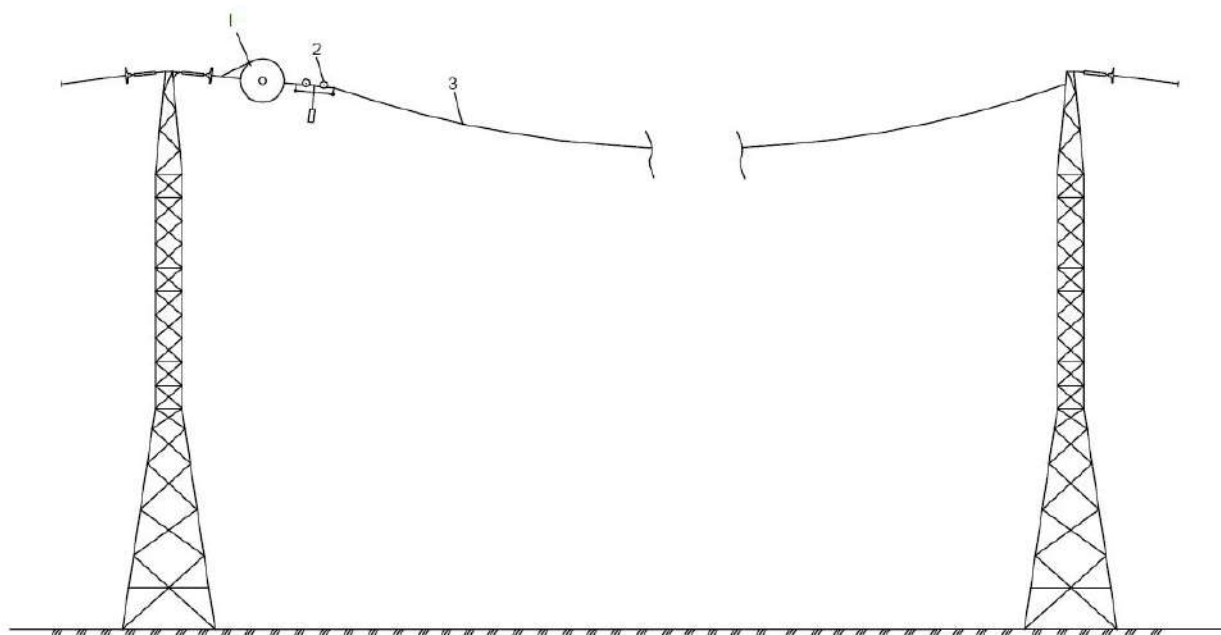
Схема расстановки механизмов и приспособлений на опоре для навивки ОКНН
